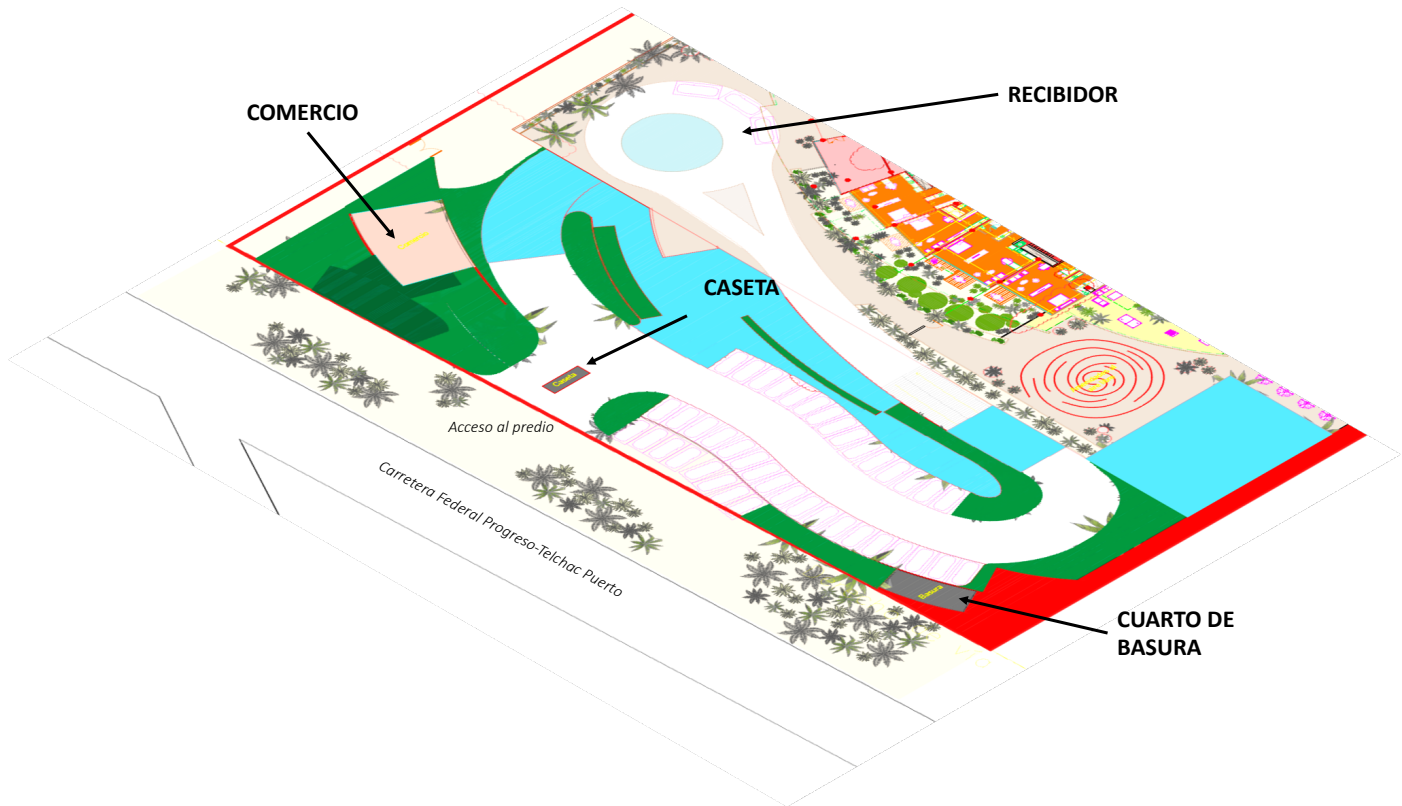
PLANTA BAJA ENTRADA PRINCIPAL
